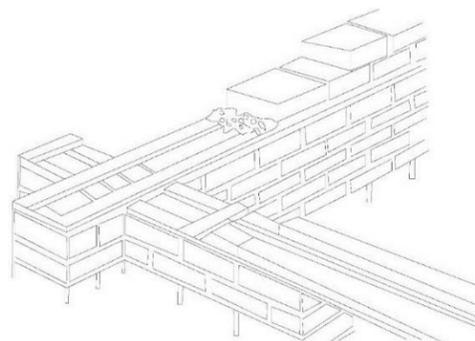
Colocación de viga corona de madera. Fuente: equipo de trabajo
